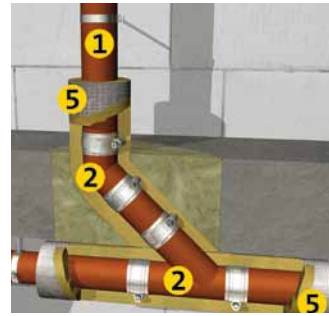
R 90 Konstruktion: Sammelleitungs-Anschlüsse von Gussrohren können durchgehend mit dem Brandschutz-Filz U TFA 34 isoliert werden.
